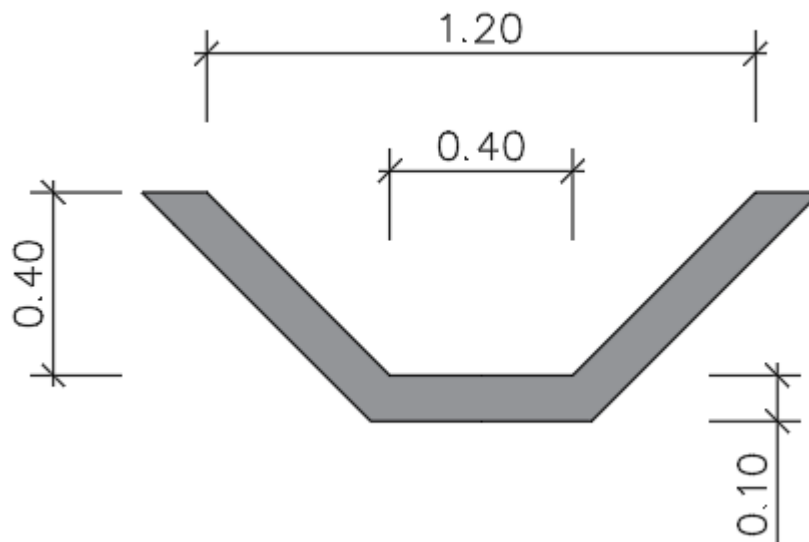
Cuneta sección trapecial. Fuente: Propia.
